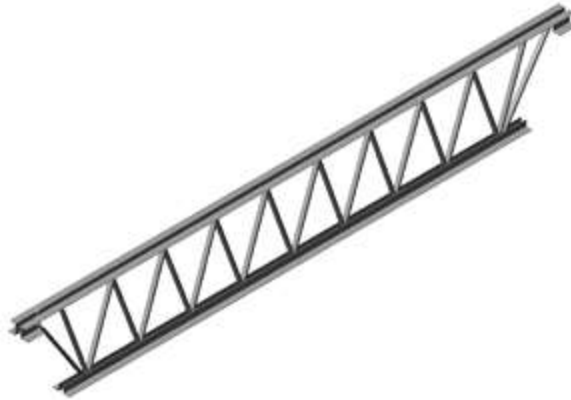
Viga de alma abierta, también llamadas vigas macomber
